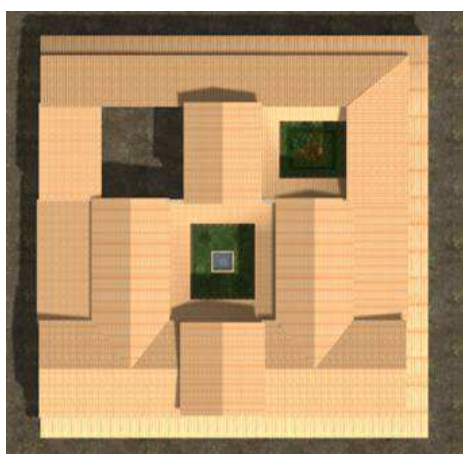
y 122. Planta y fachada ¾ del exterior de la Casa de la Exedra.
